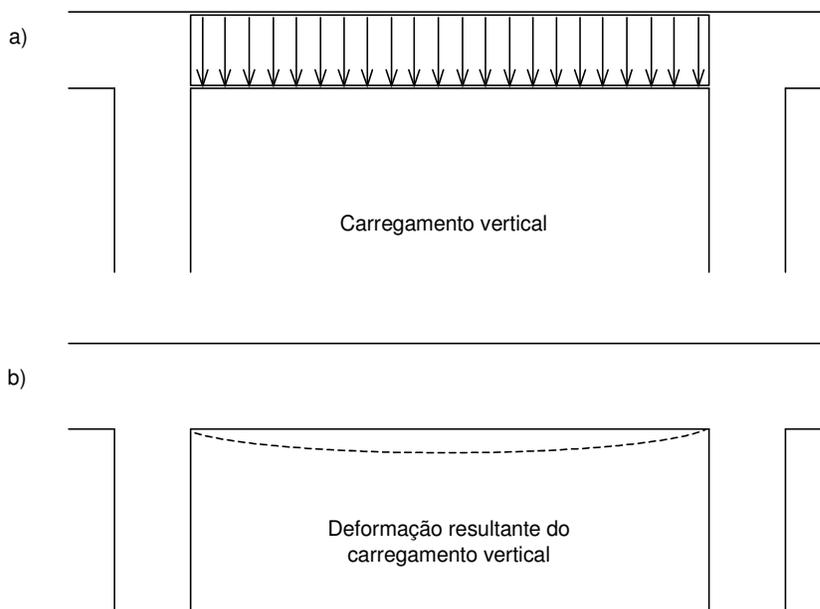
Corte longitudinal de viga representando esquematicamente: a) cargas verticais; b) deformação das fôrmas.
